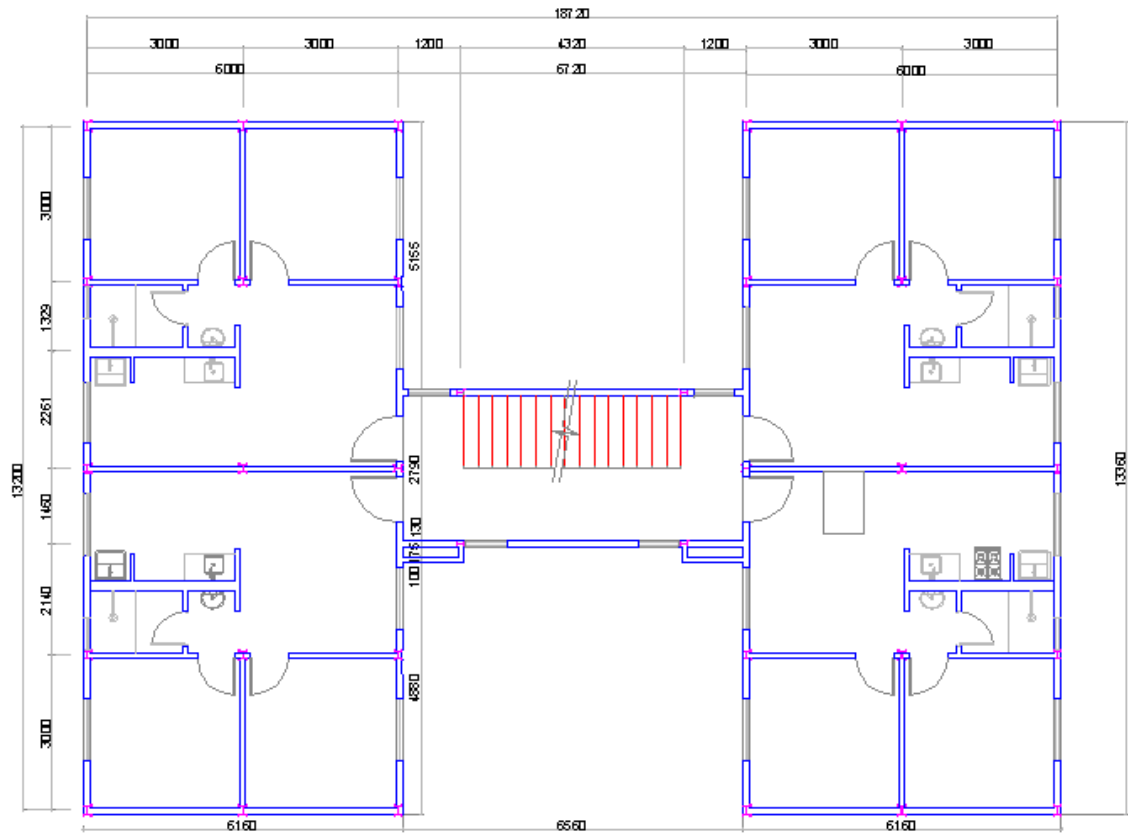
Planta Baixa do pavimento tipo do modelo tipo “B” para os sistemas aporticado e LSF
